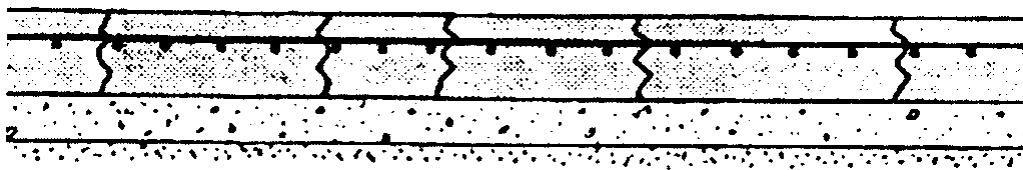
Sezioni schematiche di sovrastrutture stradali rigide con giunti o ad armatura continua.
